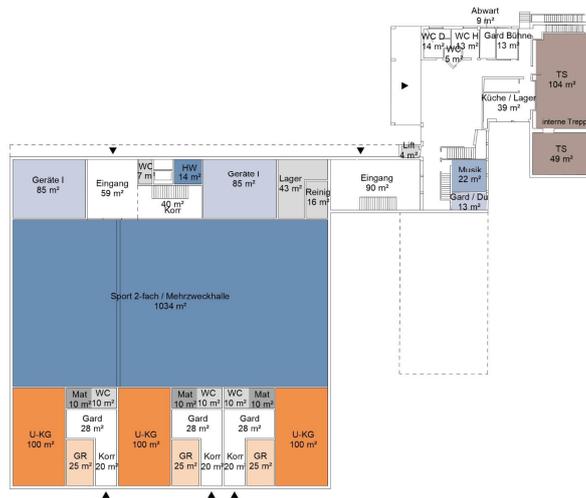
Erdgeschoss Turnhalle, Variante «violett»
